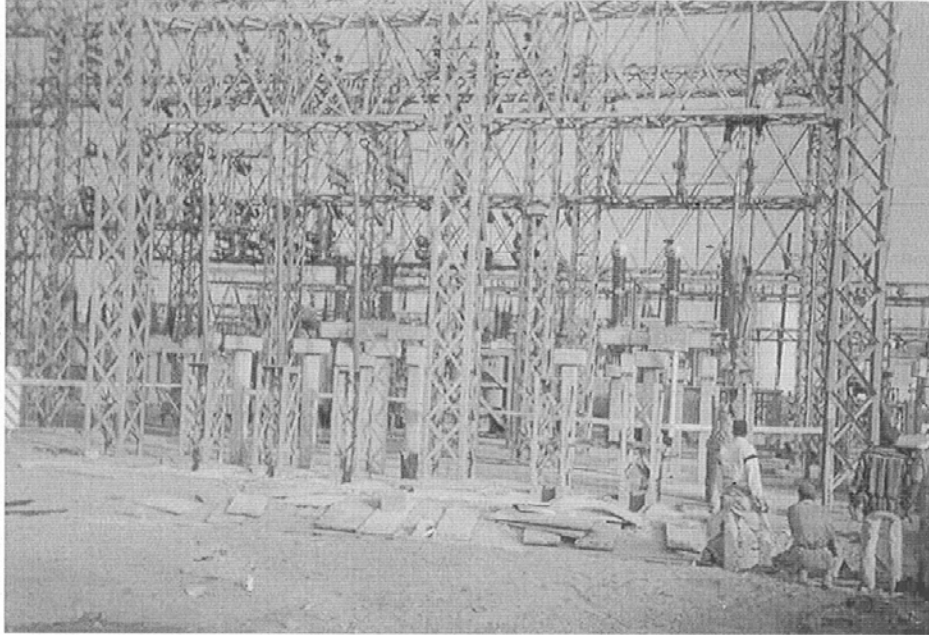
Marco de estructura metálica, habilitado y armado para la transición subterránea - aérea.
